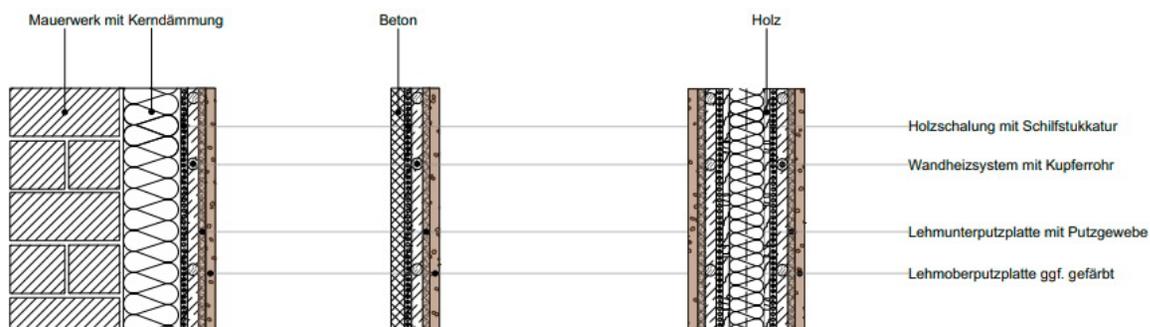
Lehm- bauplatten mit eingelassener Wandheizung an Mauerwerkswand, an Betonleichtbauwand sowie als beidseitig beplankte Holzständertrockenbauwand (eigene Darstellung)
